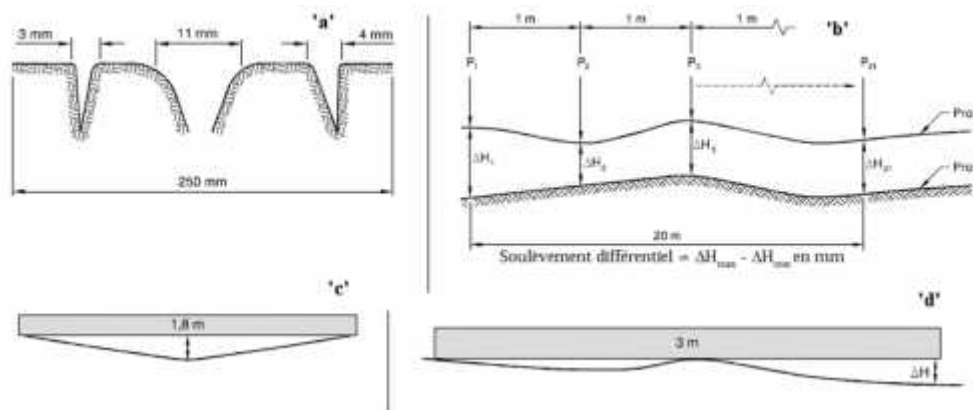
'a' Fissuration, 'b' Soulèvement différentielle, 'c' Orniérage et 'd' Affaissement (Mahoub M. et al., 2015).
